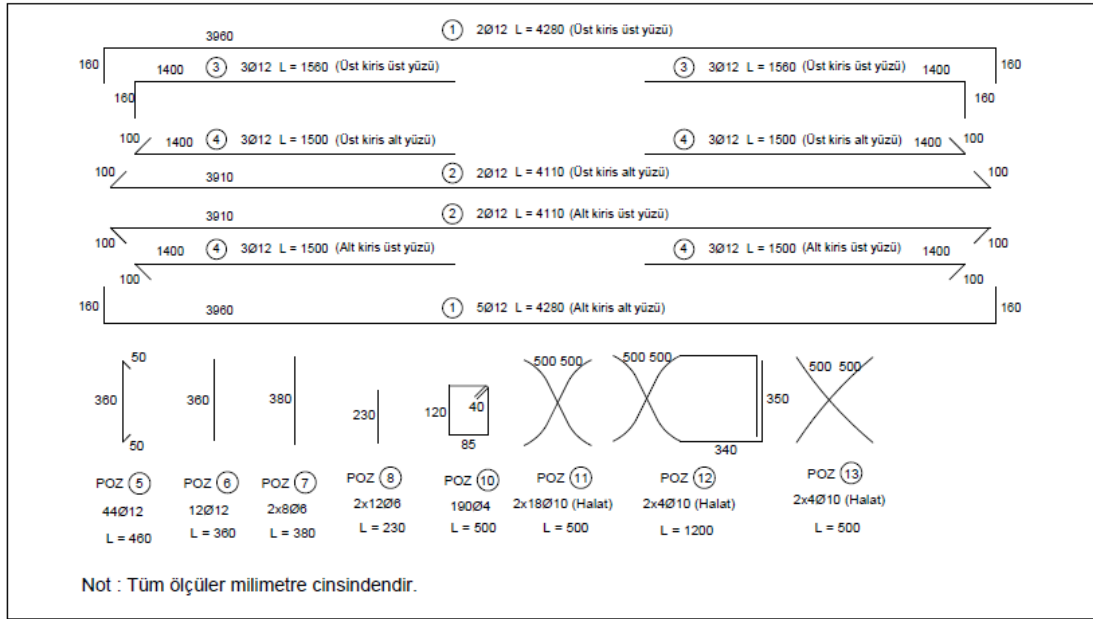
RRxcn Kirişi kiriş donatı planı ve kesitleri
